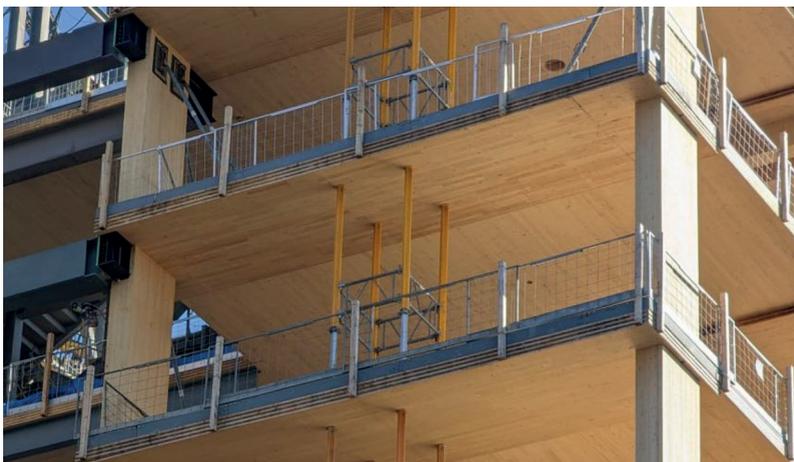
Пример применения деревожелезобетонных плит перекрытия при возведении зданий. Фотография с площадки строительства объекта Limberlost Place в Канаде
